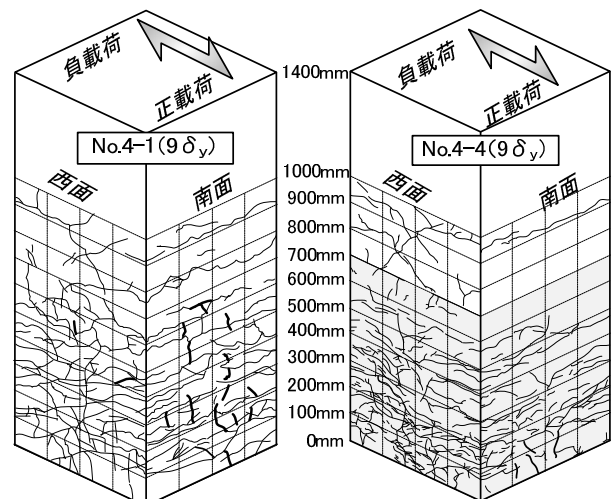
ひび割れ状況 (9 $\delta_y$ )
